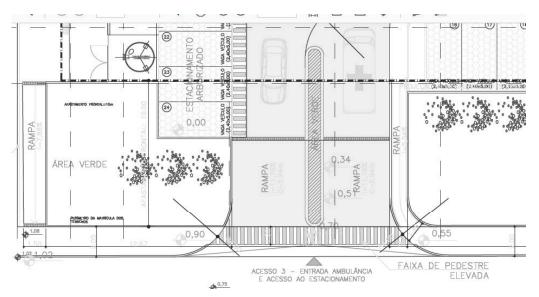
Estrutura da Calçada no Projeto do Empreendimento Fonte: Projeto Arquitetônico
